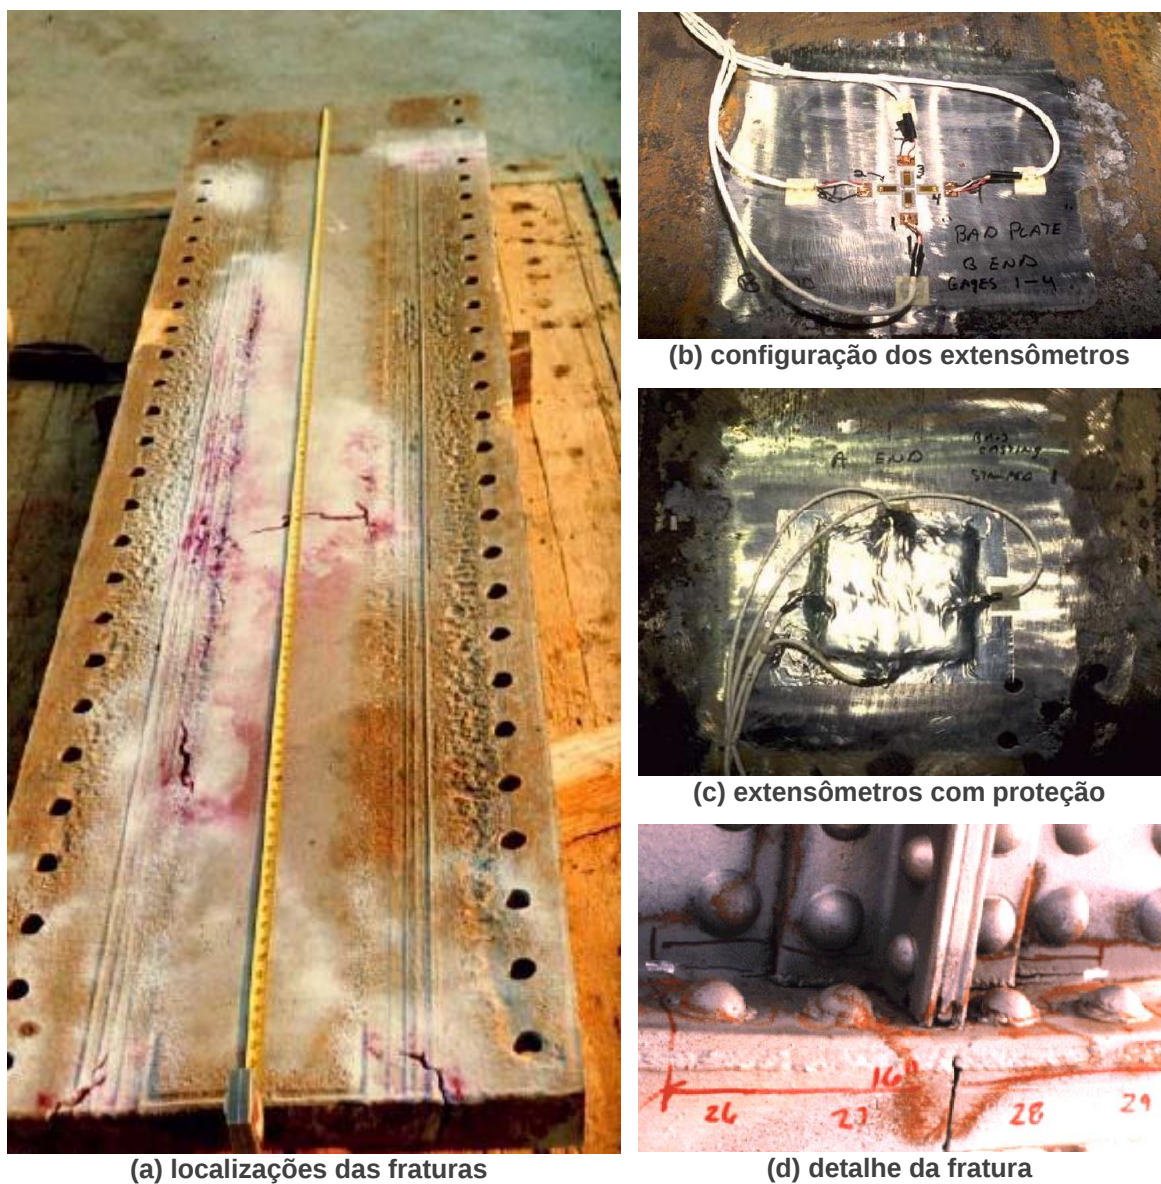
Detalhes da instrumentação e fissuras ocorridas na estrutura
